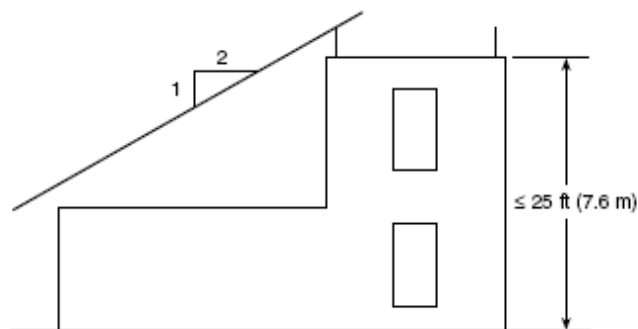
Protección de techo inferior en edificio de techo plano con altura $\leq 7,6$ m.
